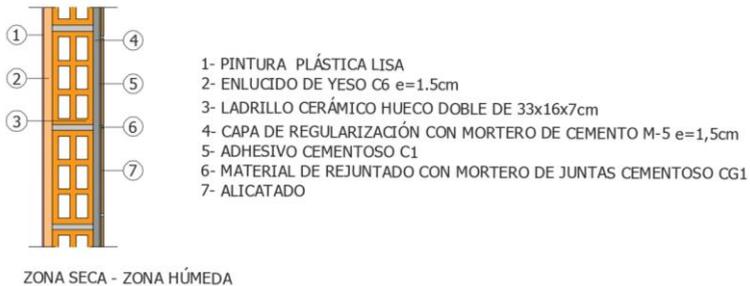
Solución constructiva entre zonas secas y húmedas de viviendas
